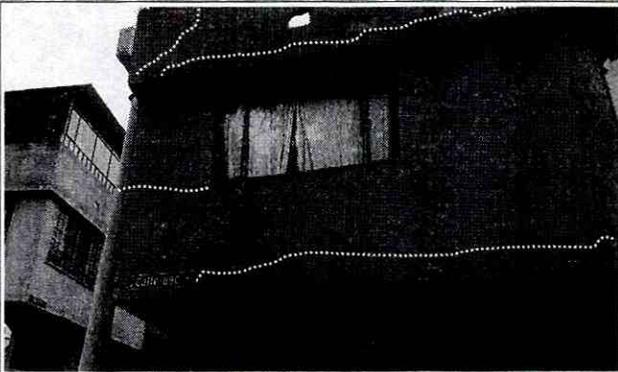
Fisuras tendencia horizontal muros perimetrales sobre la parte frontal de la vivienda – Enero de 2017
